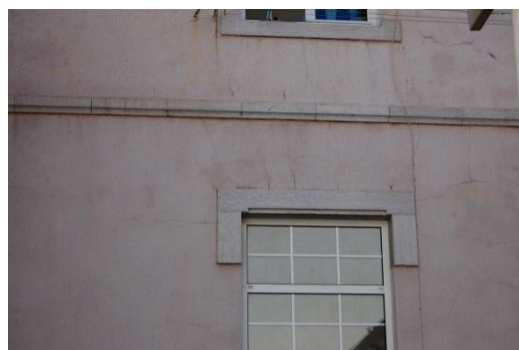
Fissuras verticais, de espessura reduzida, entre os vãos das janelas do 1º andar e RC [Fonte: Autora, Data: 31-05-2016]
